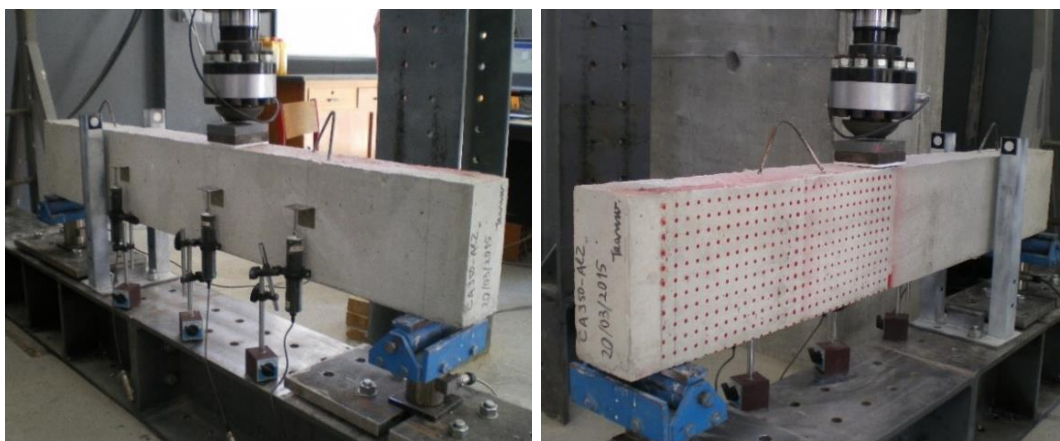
Esquema do pórtico de ensaio – ensaio ao corte
